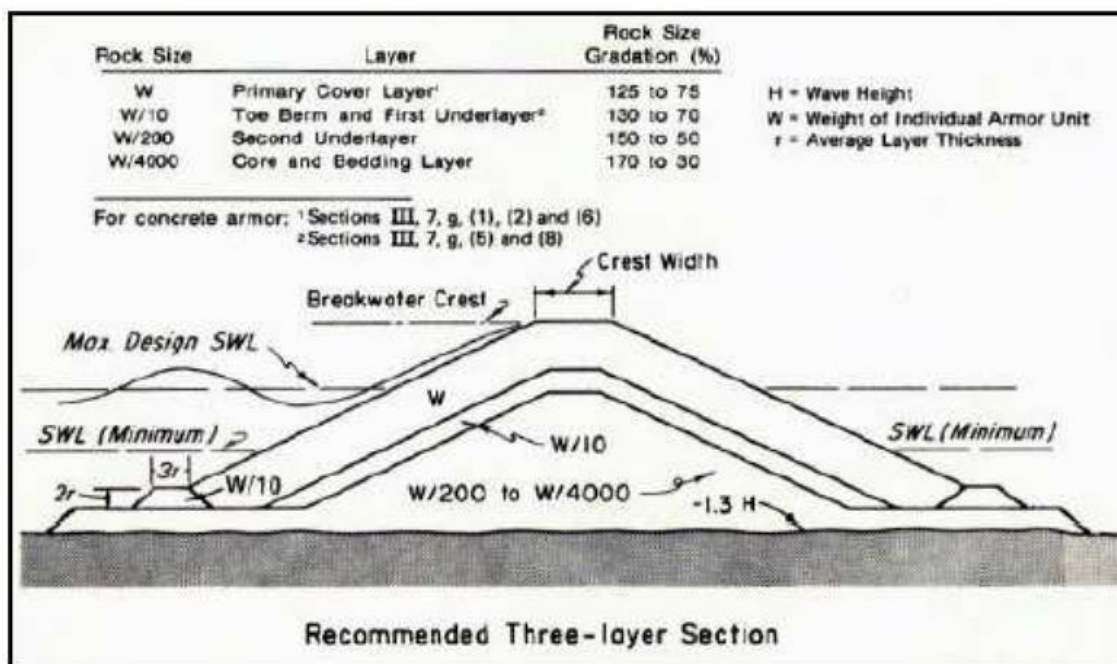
Sección tipo diques de escollera en condiciones de rotura de ola. Fuente Shore Protection Manual
